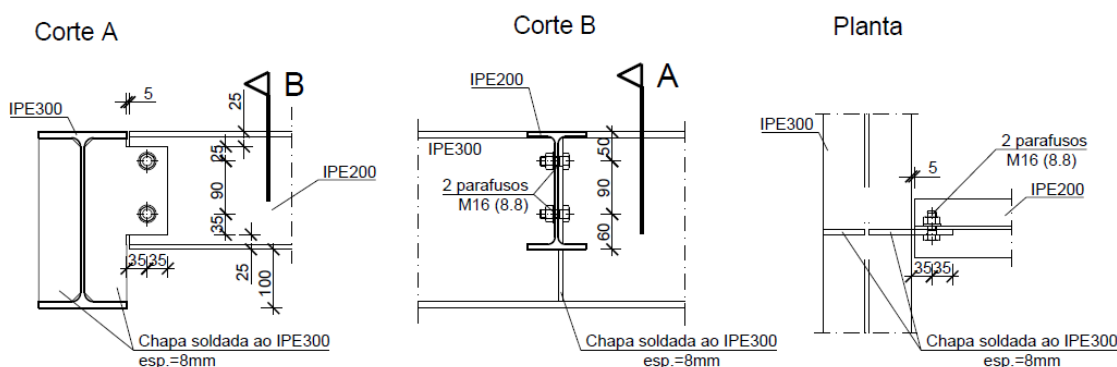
Ligação entre vigas principais e vigas secundárias.
